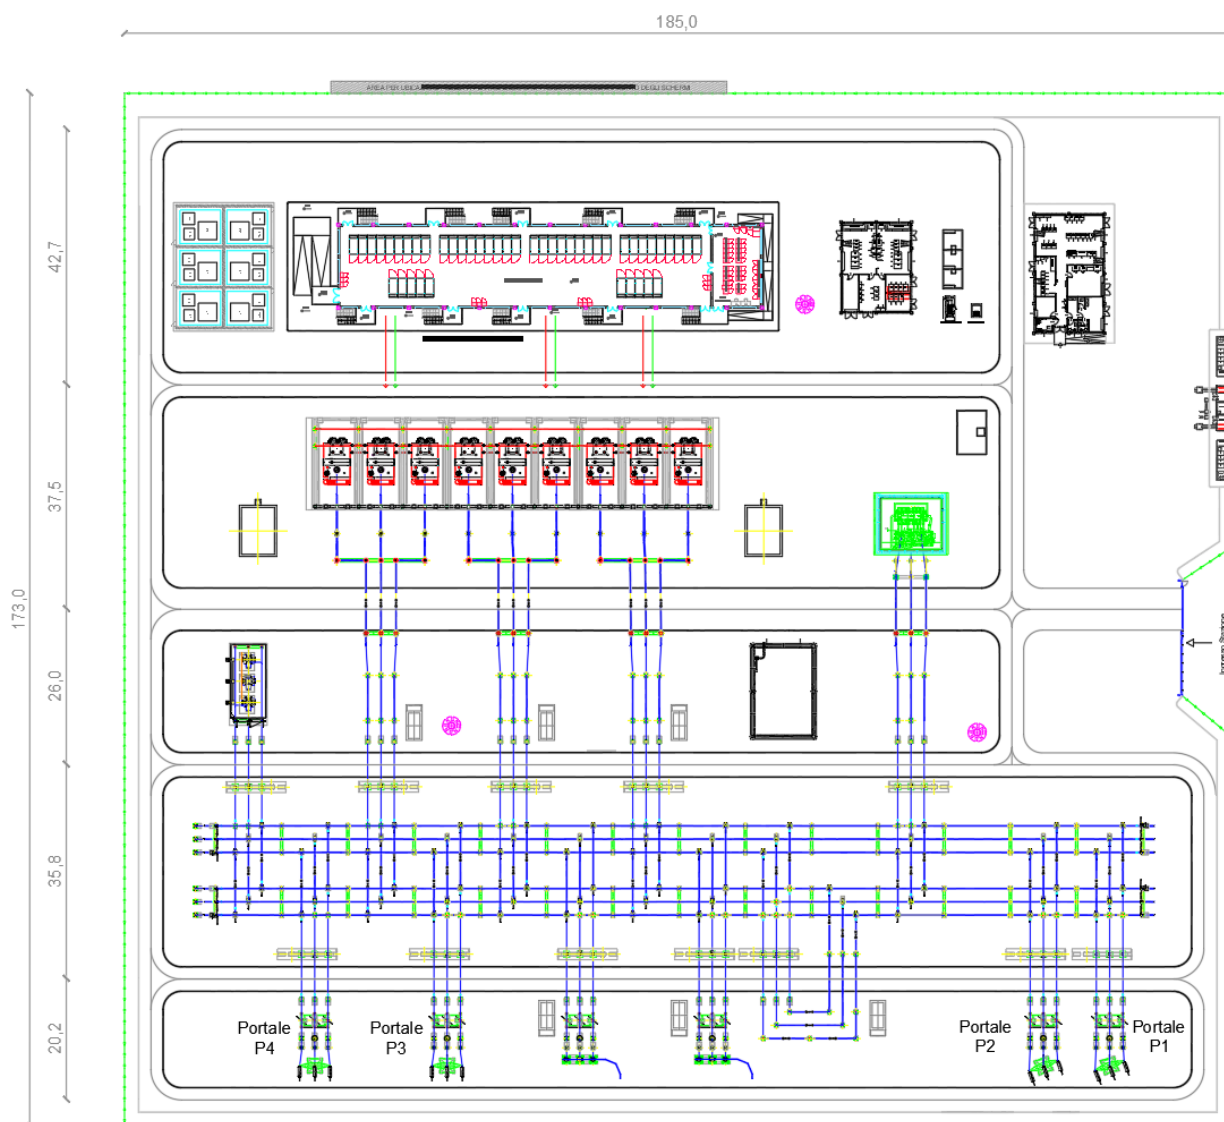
Planimetria elettromeccanica SE RTN 150/36 kV
